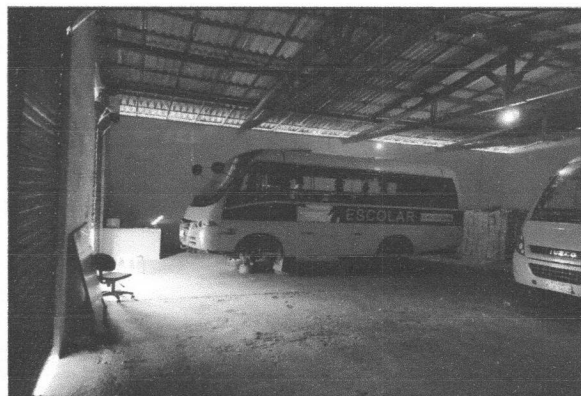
Vista do Galpão, com destaque ao piso cimentado.
